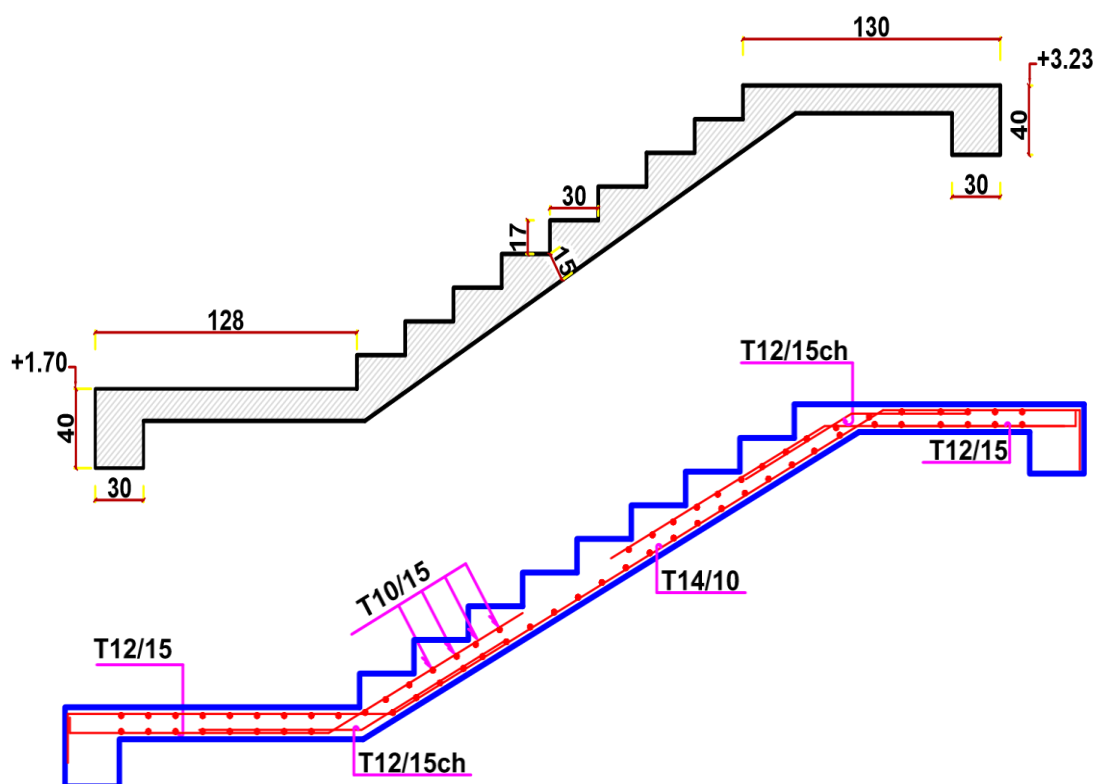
Schéma de coffrage et ferrailage de l'escalier
